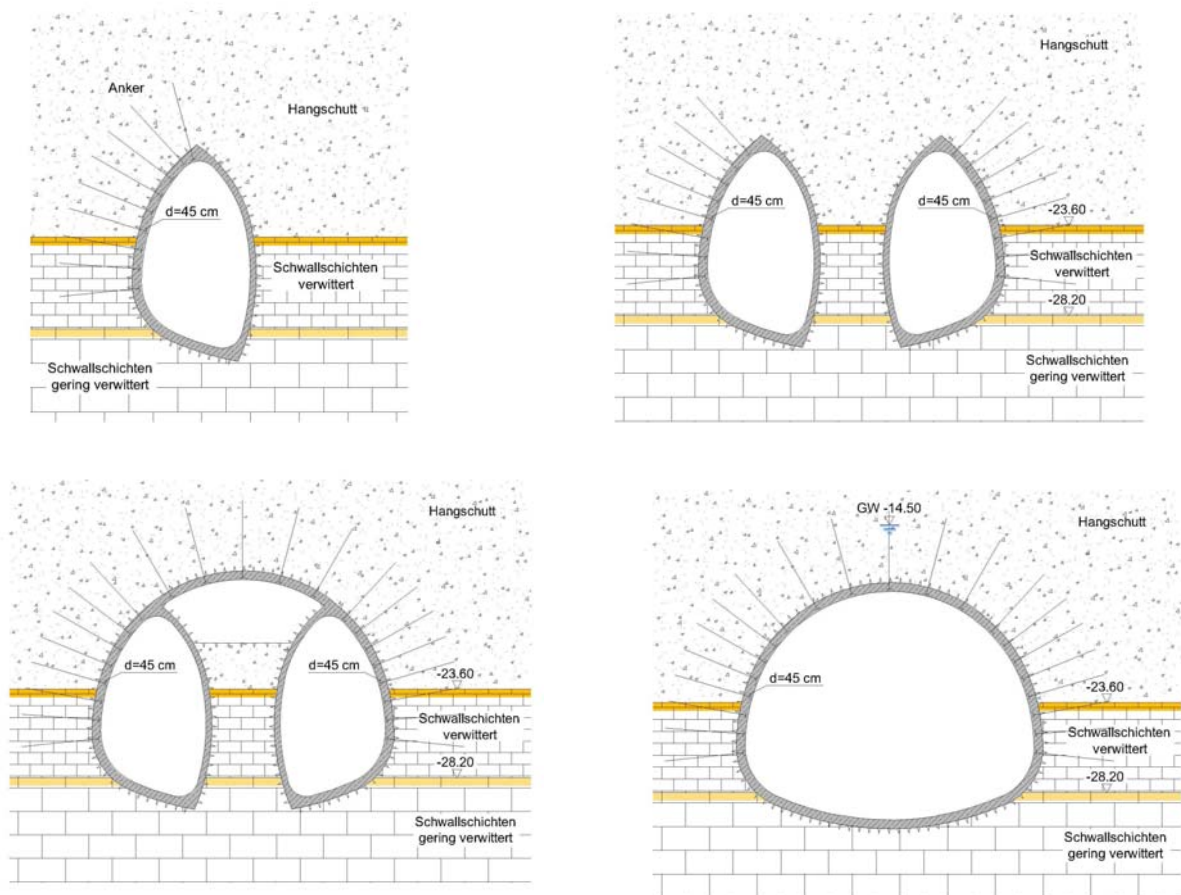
Tunnel in Spritzbetonbauweise, untersuchte Bauzustände
